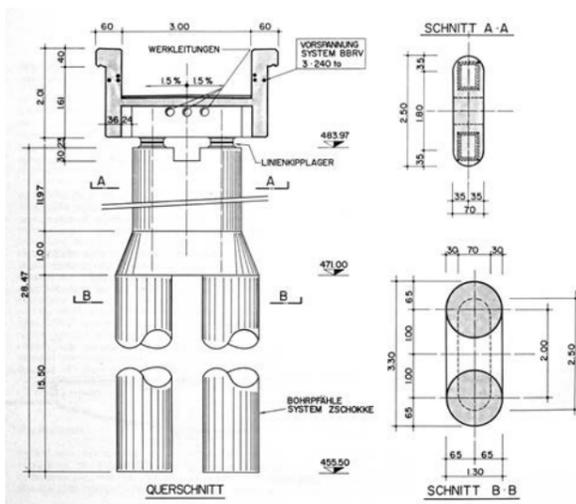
Querschnitt des Betonstegs Trübbach-Mäls.
